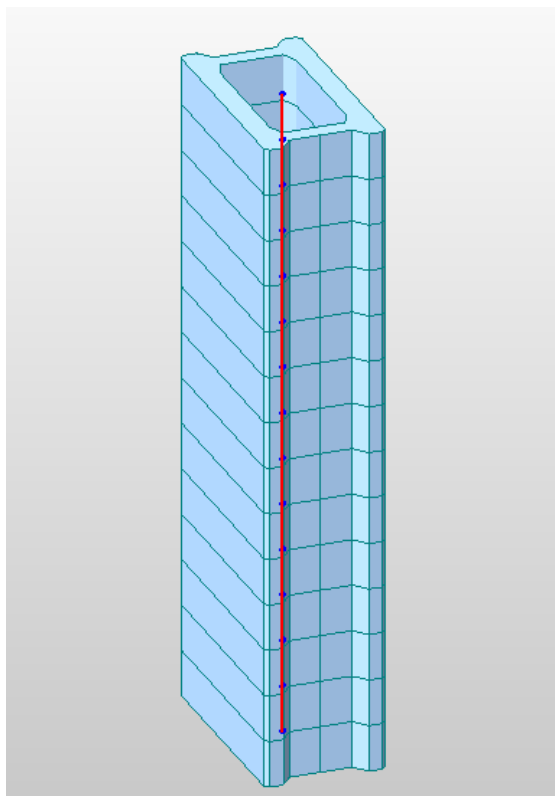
Elemento beam rappresentativo della pila tipo
